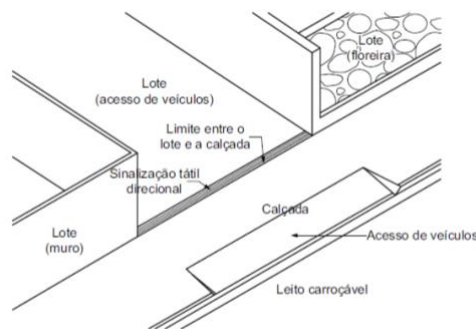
Alinhamento de lote não edificado, entre outros lotes edificados
